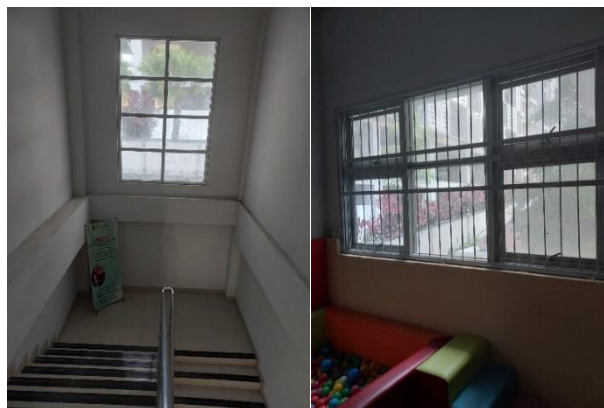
Fasilitas pada Lantai 2 Rumah Layanan Autis Kota Semarang
